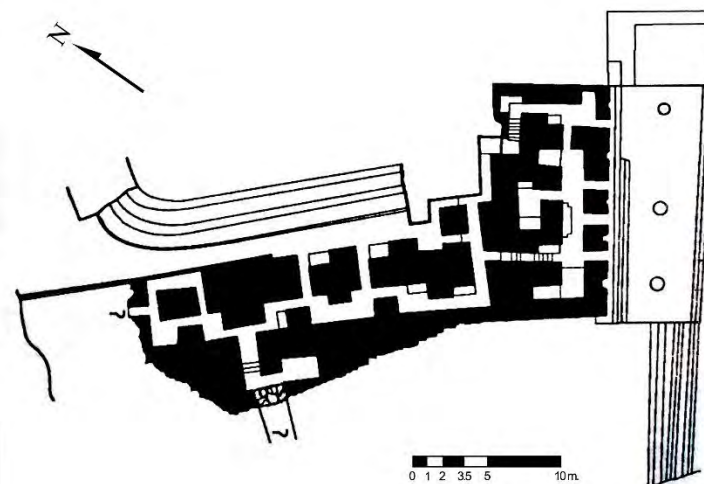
Planta arquitectónica del Edificio 19, Yaxchilán, Chiapas.
